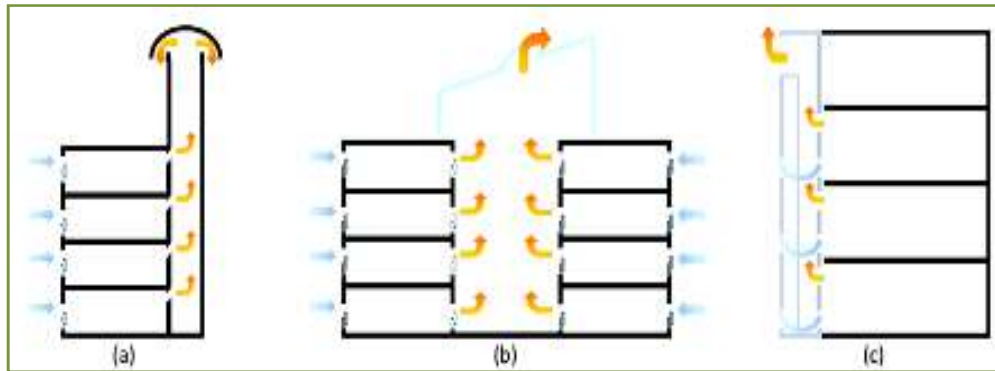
Exemple de solutions architecturales favorisant la ventilation traversante.
